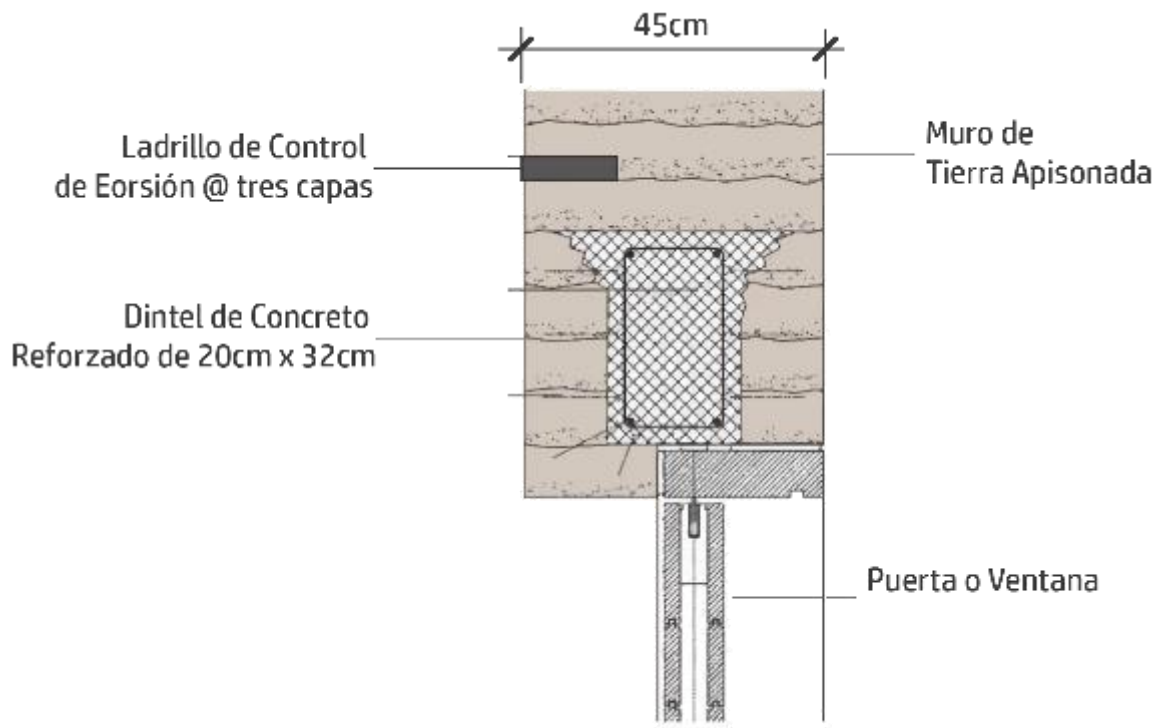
Muro de Tierra Apisonada. Fuente: Martin Rauch Refined earth construction and design with rammed earth
